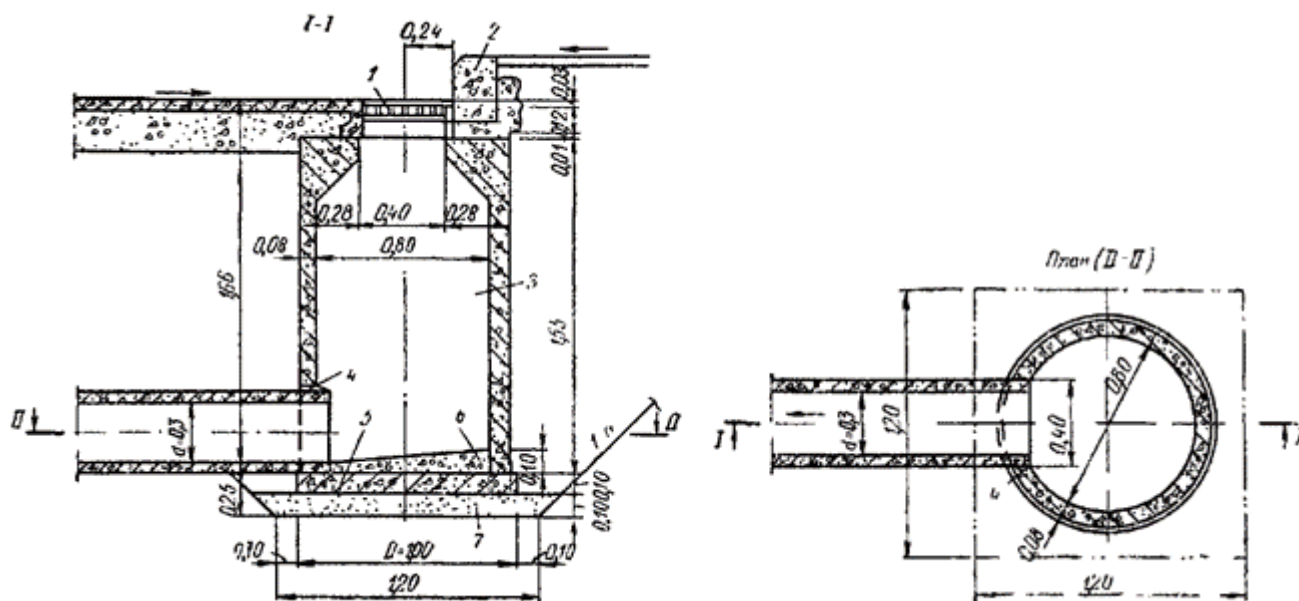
Схематический разрез смонтированного дождеприемного колодца
